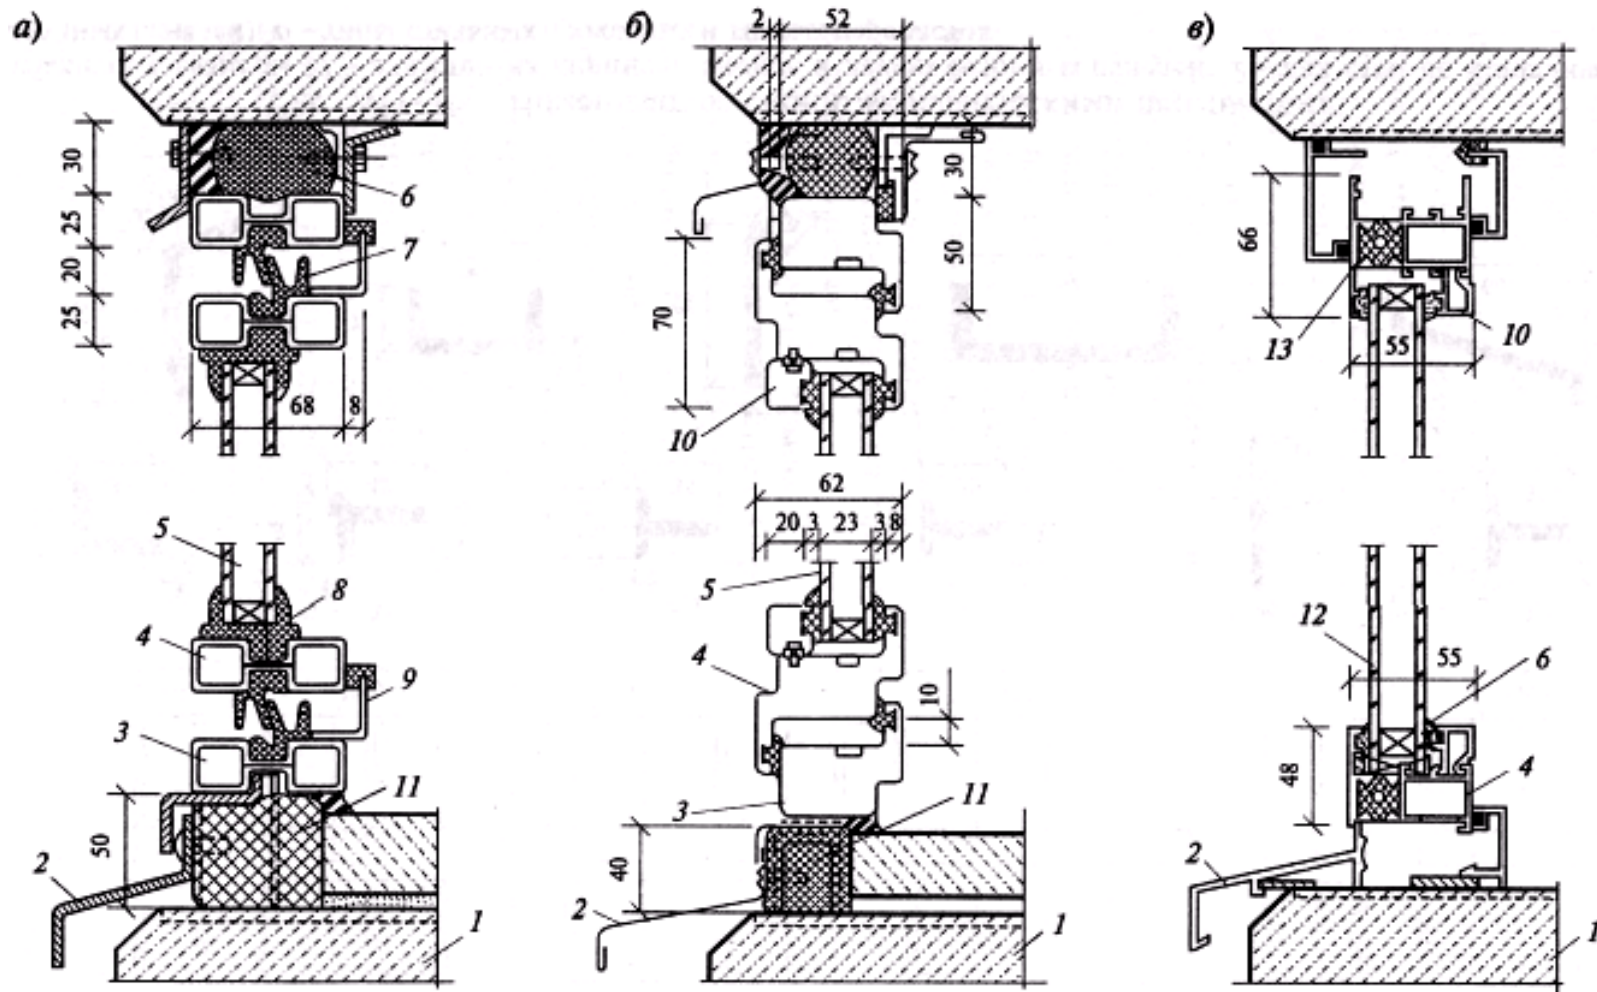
Конструкции окон с металлическими переплетами:
